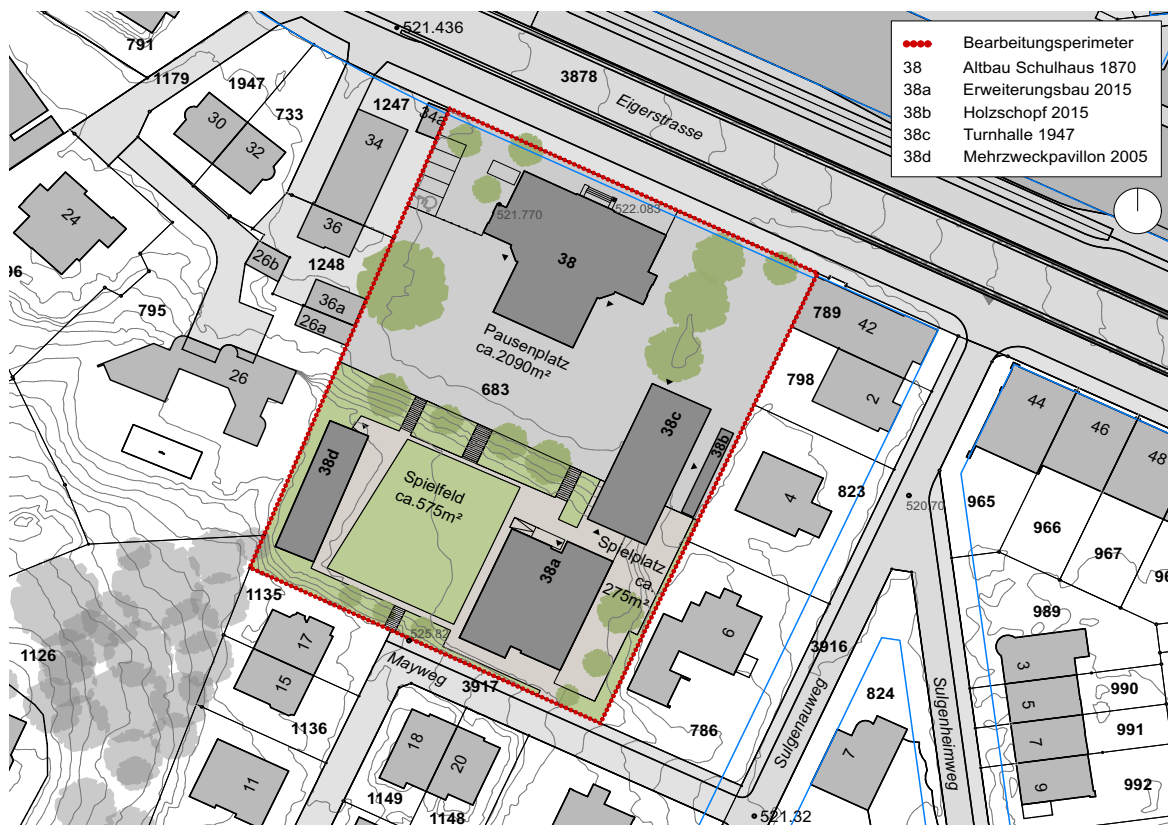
Übersichtsplan, Hochbau Stadt Bern
